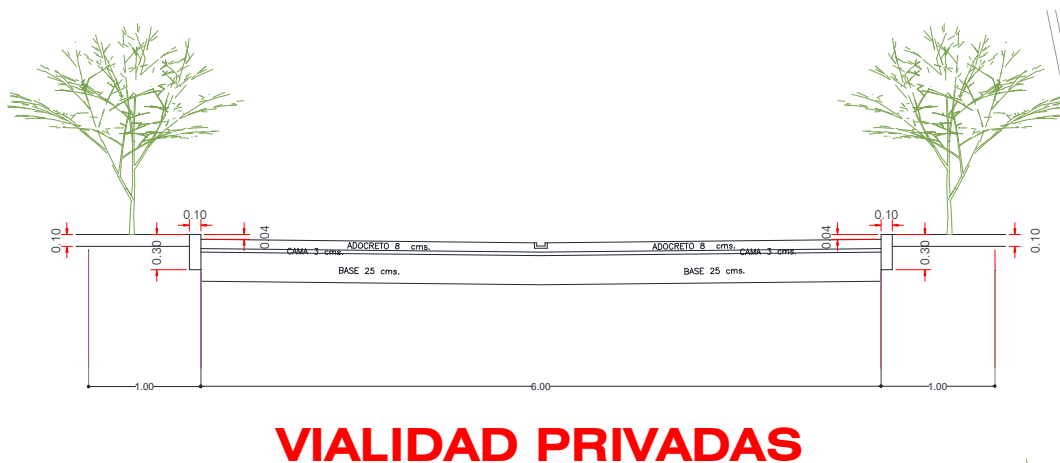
Estructura de Pavimento Vialidad Privadas
